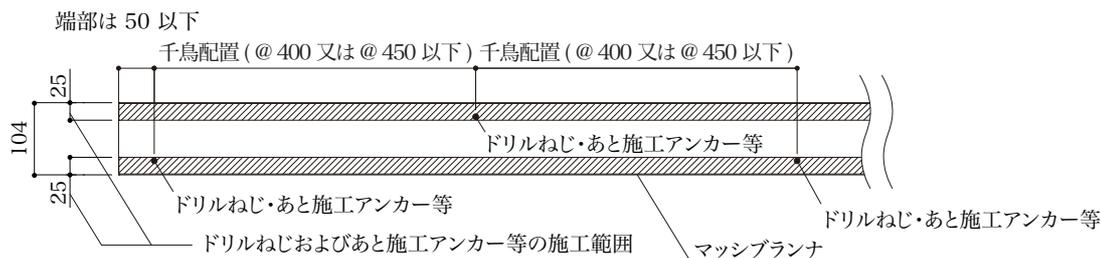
ドリルねじおよびあと施工アンカー等の配置と施工範囲 (単位: mm)
